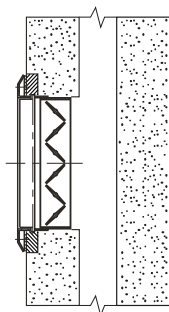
Схема установки решеток вентиляционных типа РШ-1, РШ-2, РШ-4 в проеме вентиляционного канала.
